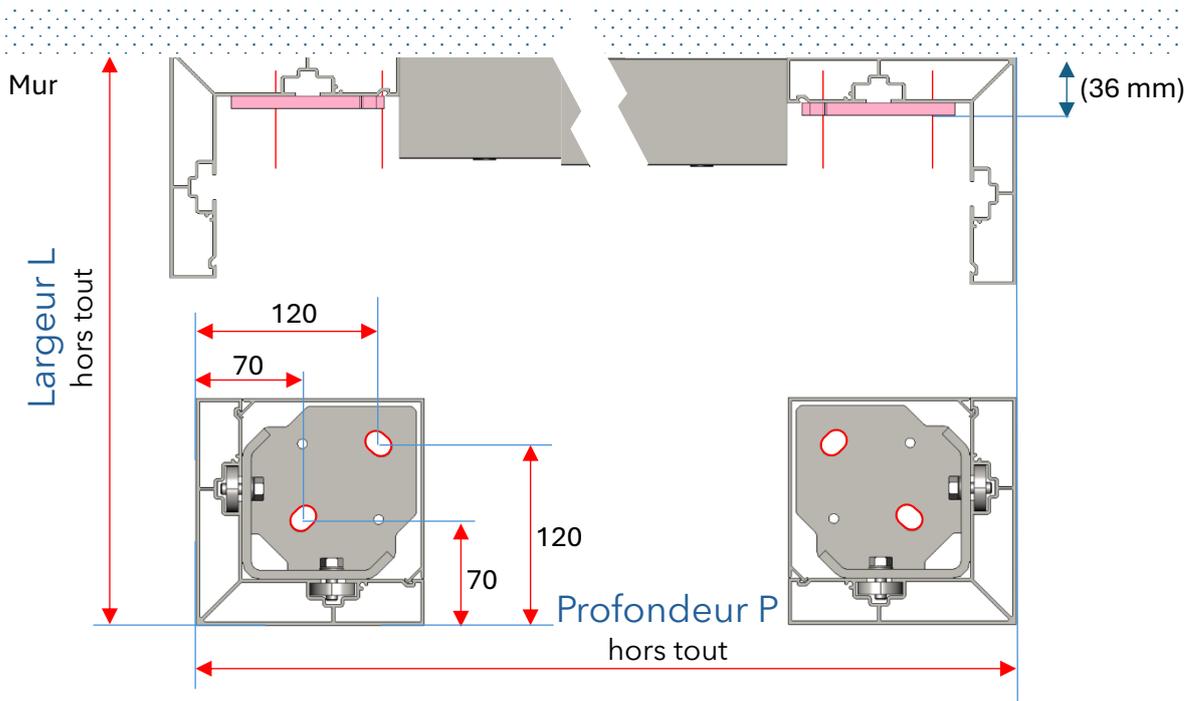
DETAILS FIXATION MURALE - POSE ADOSSÉE (fixation standard dans les angles)
